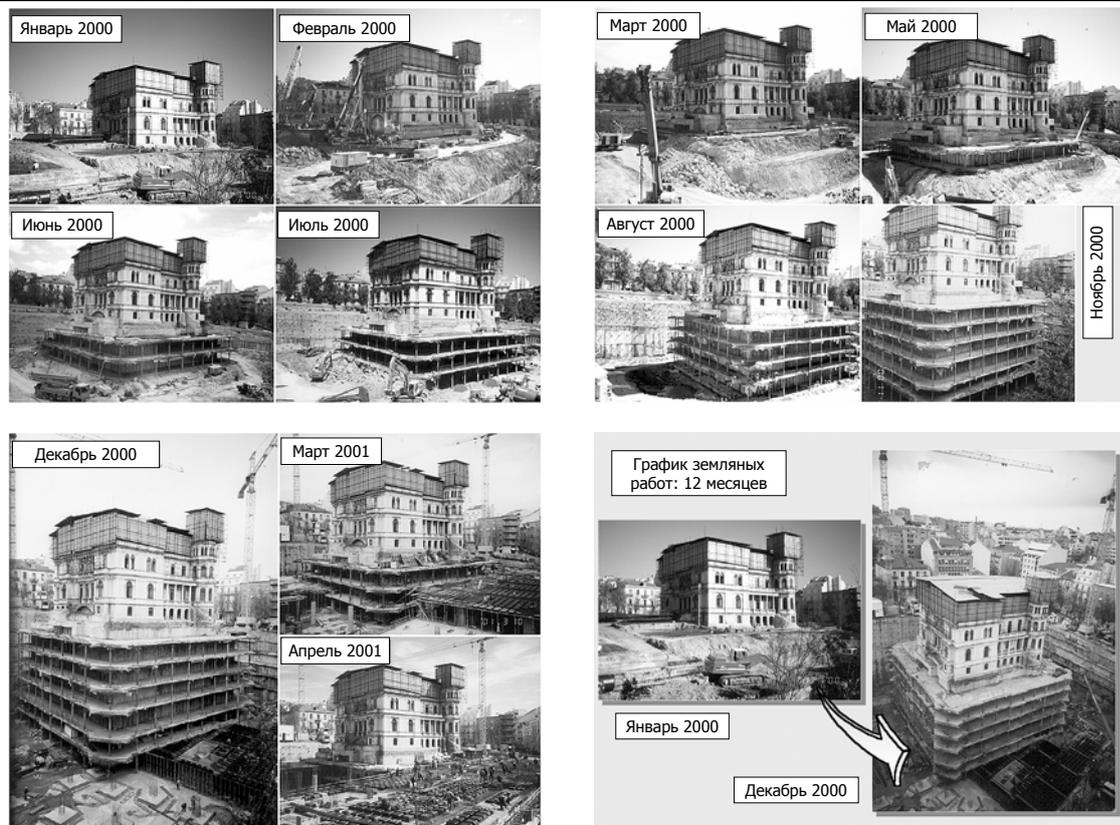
Общий вид котлована и последовательность строительства плит вокруг дворца нагрузки–разгрузки с дополнительной установкой электрических мессдоз.
